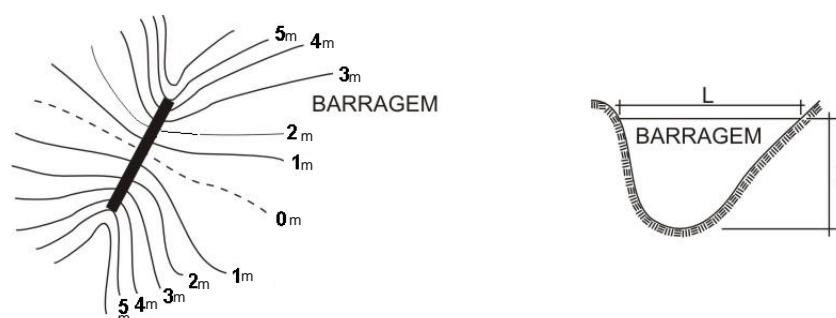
Planta e perfil transversal de uma barragem, a isolinha de 0m corresponde a barragem.
